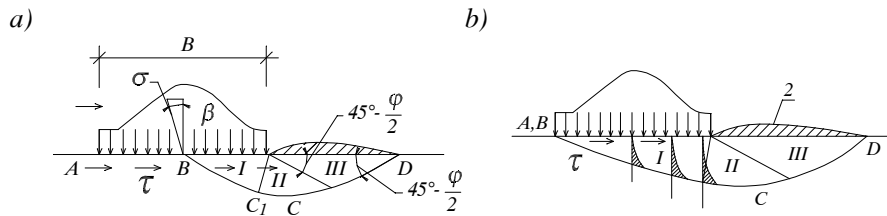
Sơ đồ tính toán trượt sâu và trượt hỗn hợp
